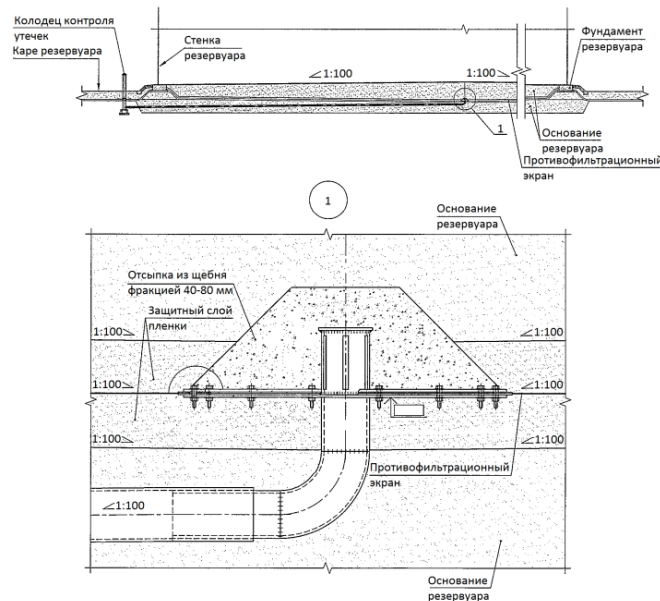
Конструкция системы обнаружения утечек под днищем резервуара (для резервуара с железобетонным кольцевым фундаментом)
